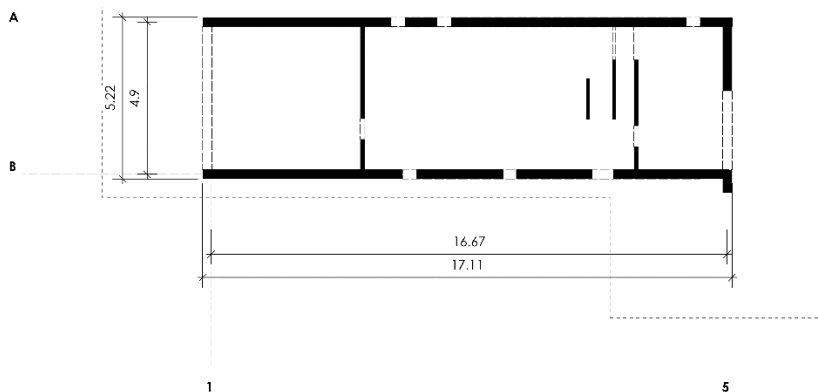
Esquema gráfico de la modulación estructural en planta baja. Fuente: Autor.
